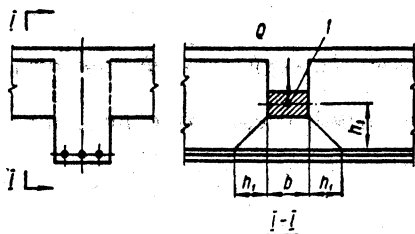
Схема передачи усилий при расчете железобетонных элементов на отрыв: I — центр тяжести сжатой зоны.
